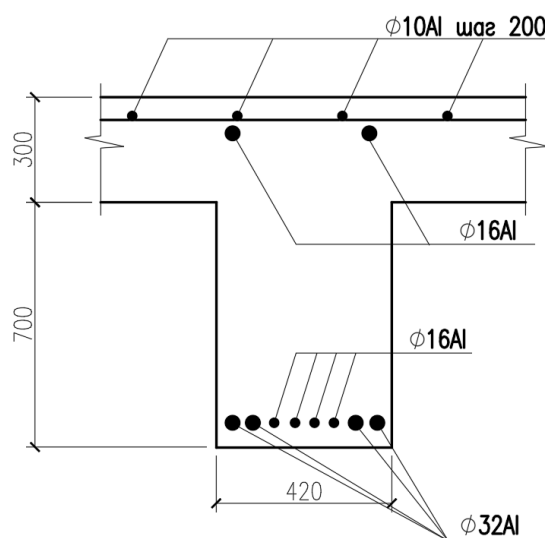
Армирование главной балки и плиты перекрытия
